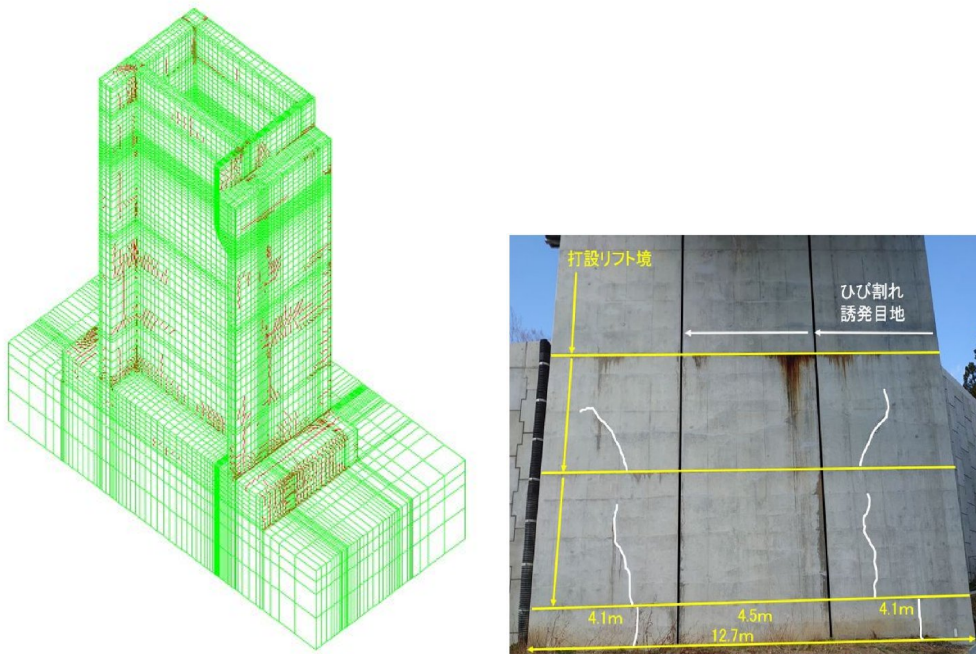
引張強度を75%程度と仮定した場合のひび割れパターン図と実際の写真
